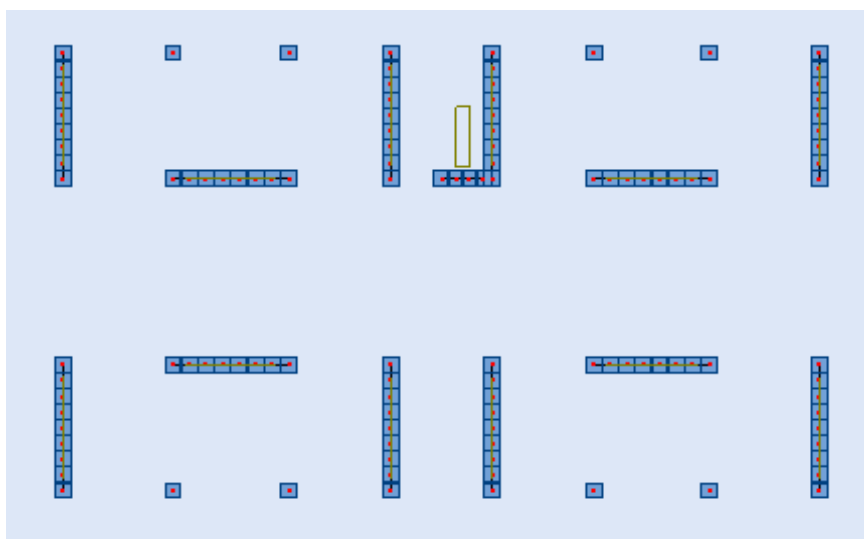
La 2^{ème} disposition des murs voiles et poteaux
